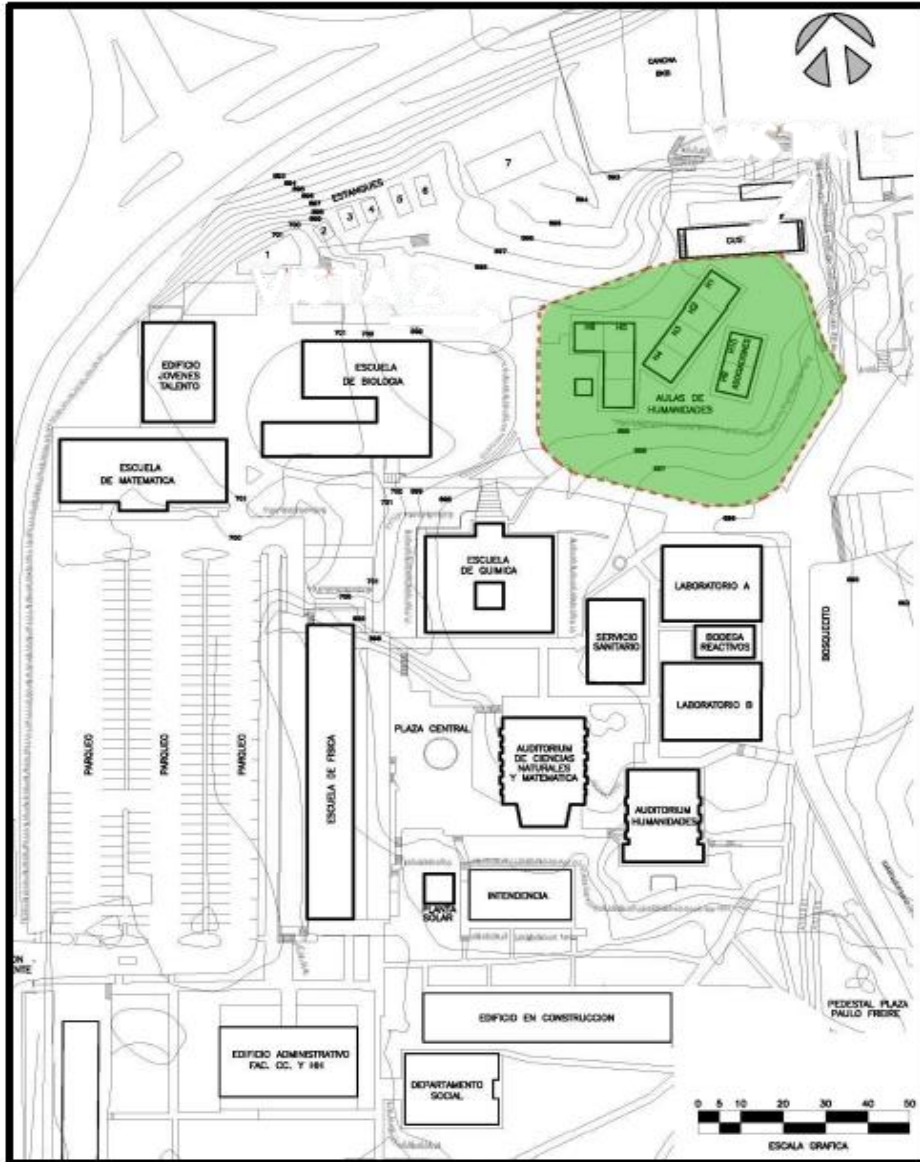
Plano de Ubicación de Terreno Alternativa 1.
